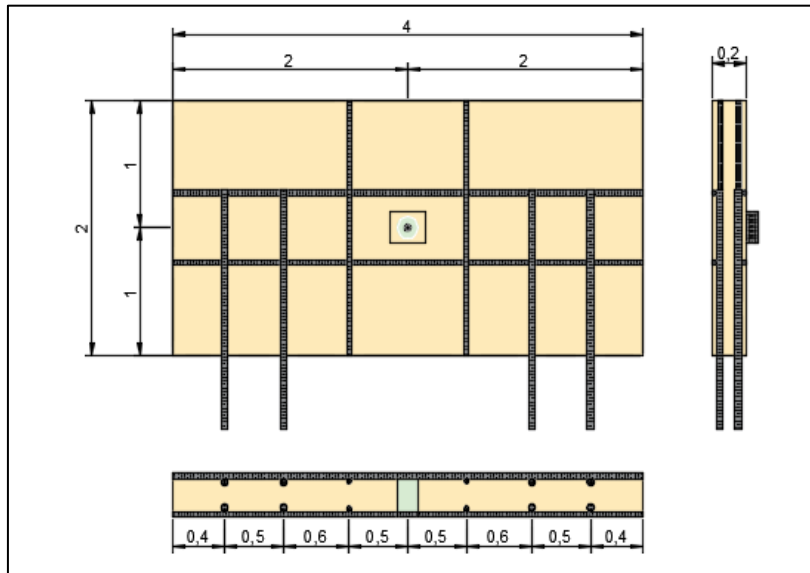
Esquema panel prefabricado (Modelo 3). Fuente: Propia
